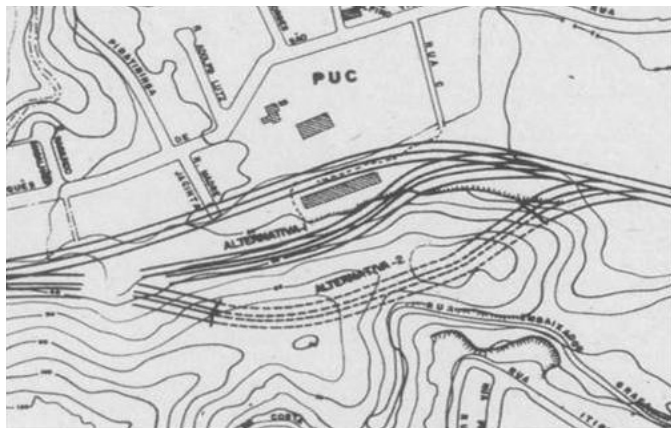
Alternativas de implantação do túnel da Autoestrada Lagoa-Barra.
